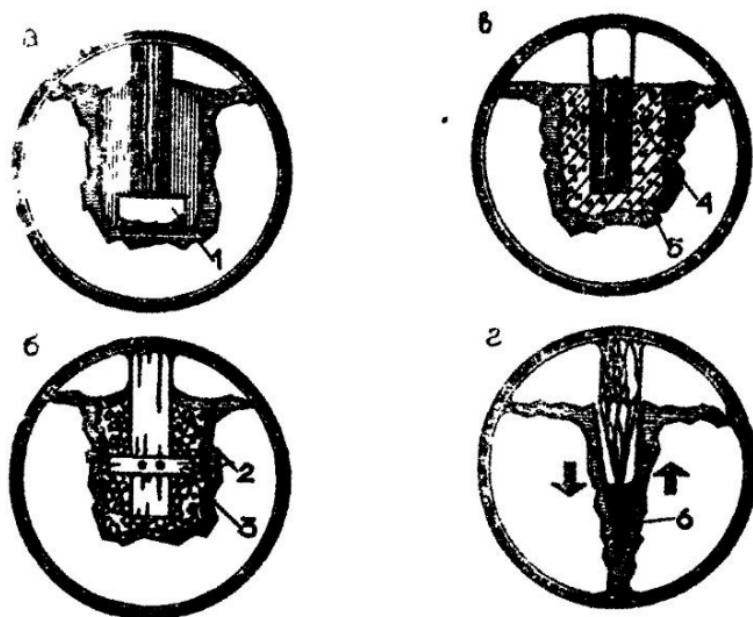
Способы крепления опорных столбов для изгороди: а — в твердом грунте, б, в — в мягком грунте, г — крепление длинных колышей, 1 — камень, 2 — мелкие камни, 3 — перекладина, 4 — битум или деготь, 5 — бетон, 6 — вода
